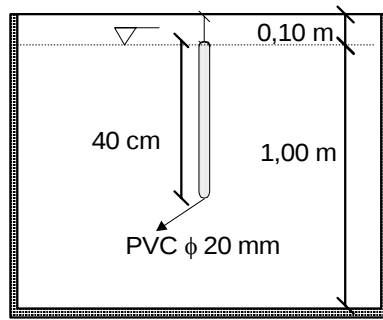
Lagoa 1 - corte AA da planta baixa
